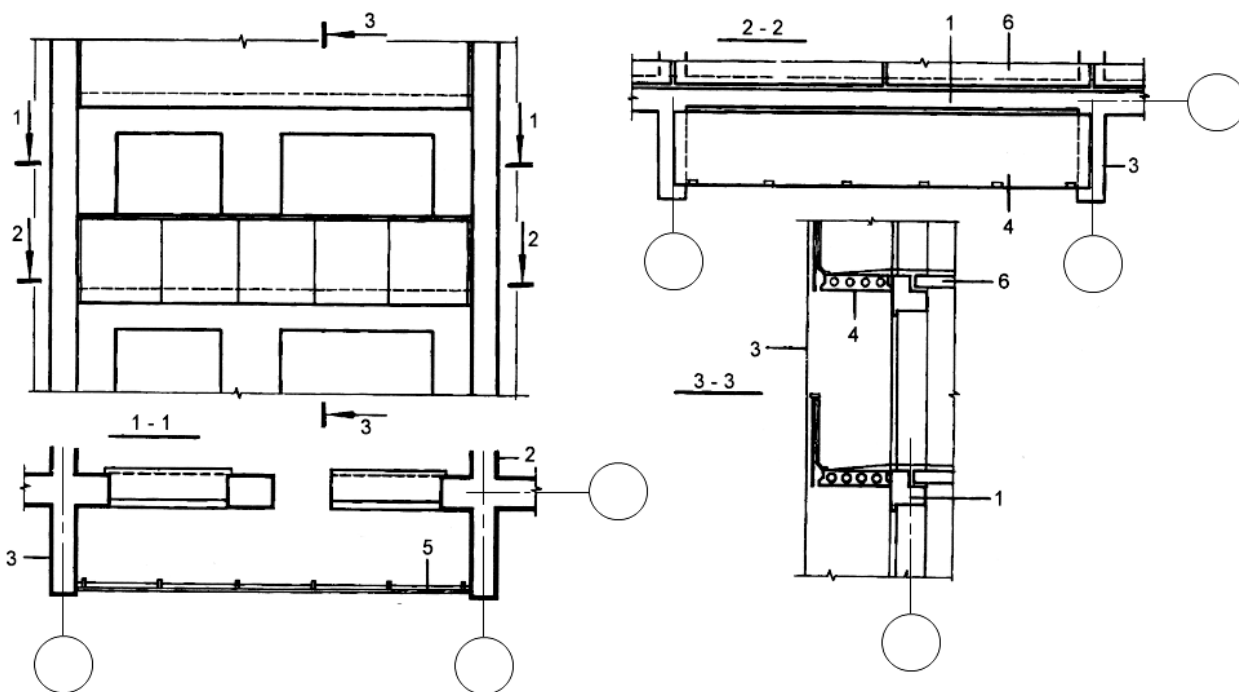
Схема фасада и план выносной лоджии в здании с кирпичными стенами:
